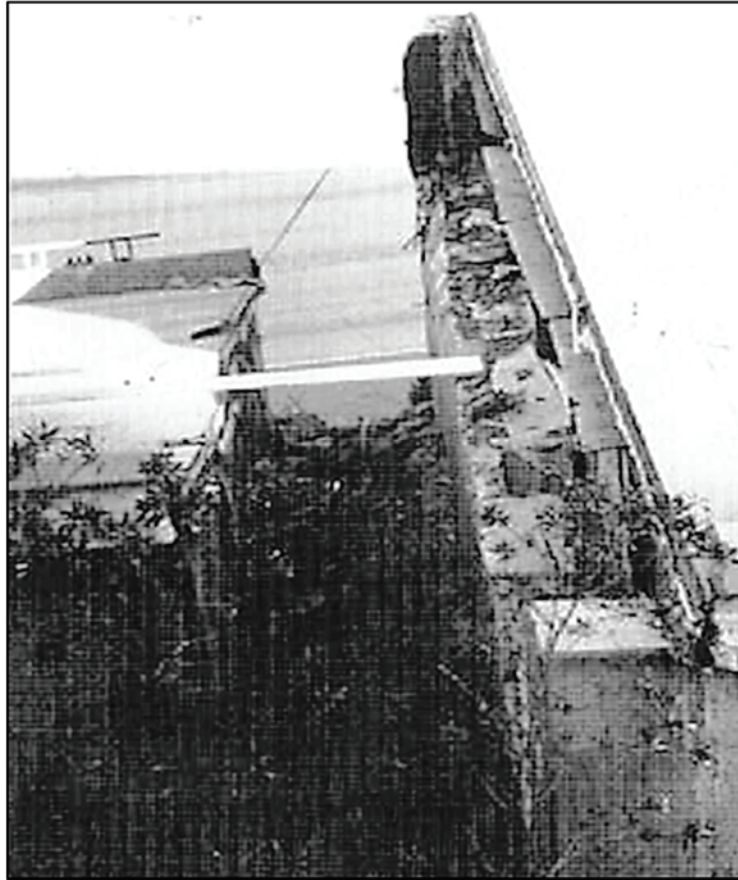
Acceso Sur al Conector Sur I-5/SR14. Ausencia de conexión positiva del tablero al muro de apoyo, dejó un desplazamiento permanente de 5 pies. (Fuente: Earthquake Spectra, 1995, p. 345)
